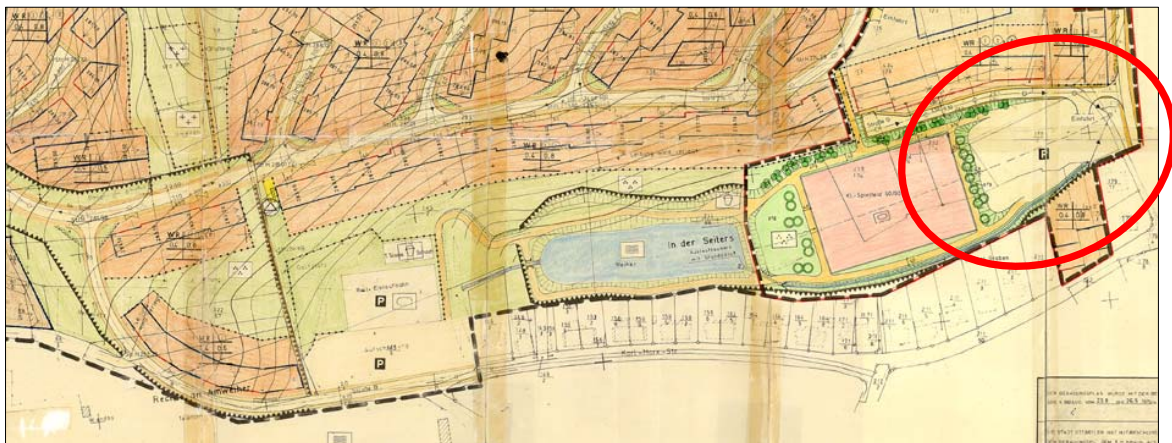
Bebauungsplan „Auf'm Burg“, rechtskräftiger Stand mit Lage des Änderungsbereichs
